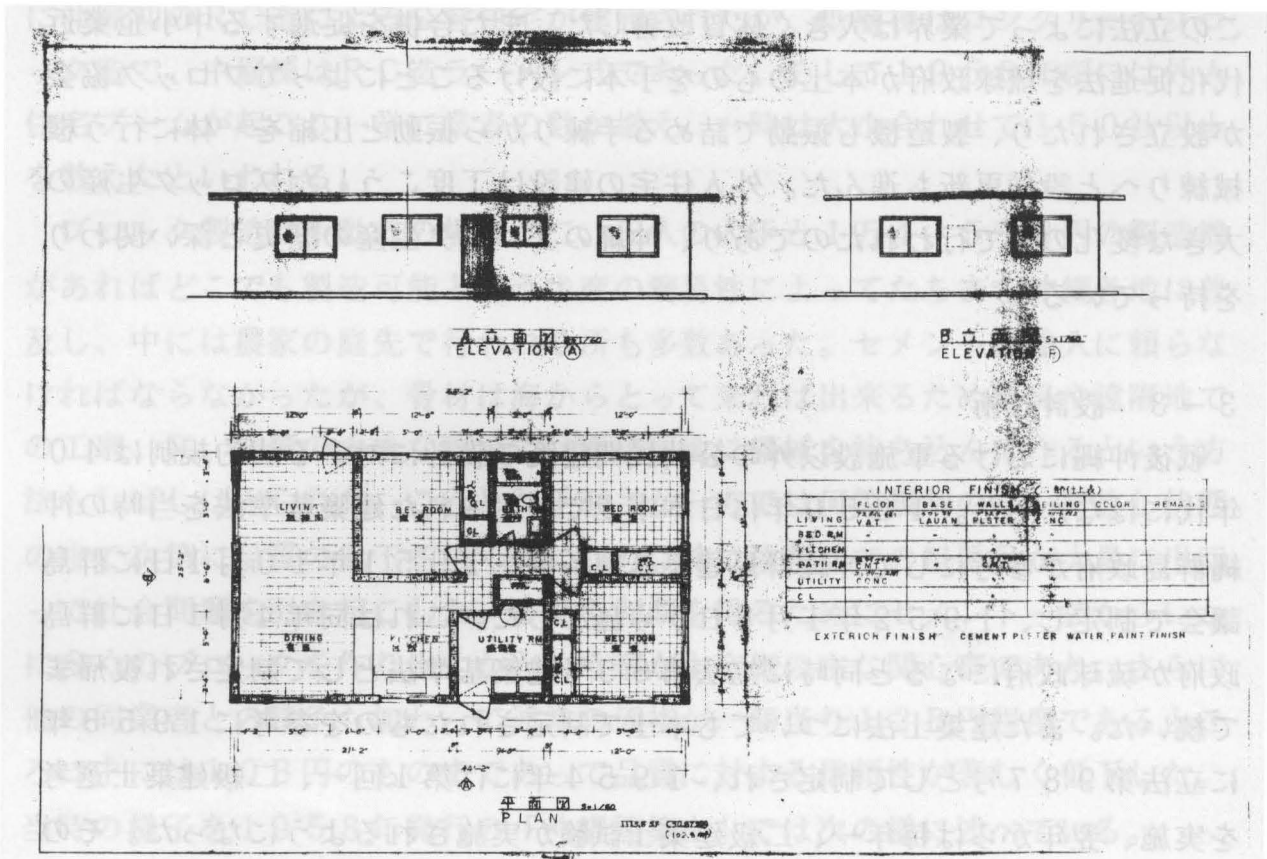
外人住宅平面図及び立面図 (3ベッドルームタイプ)
